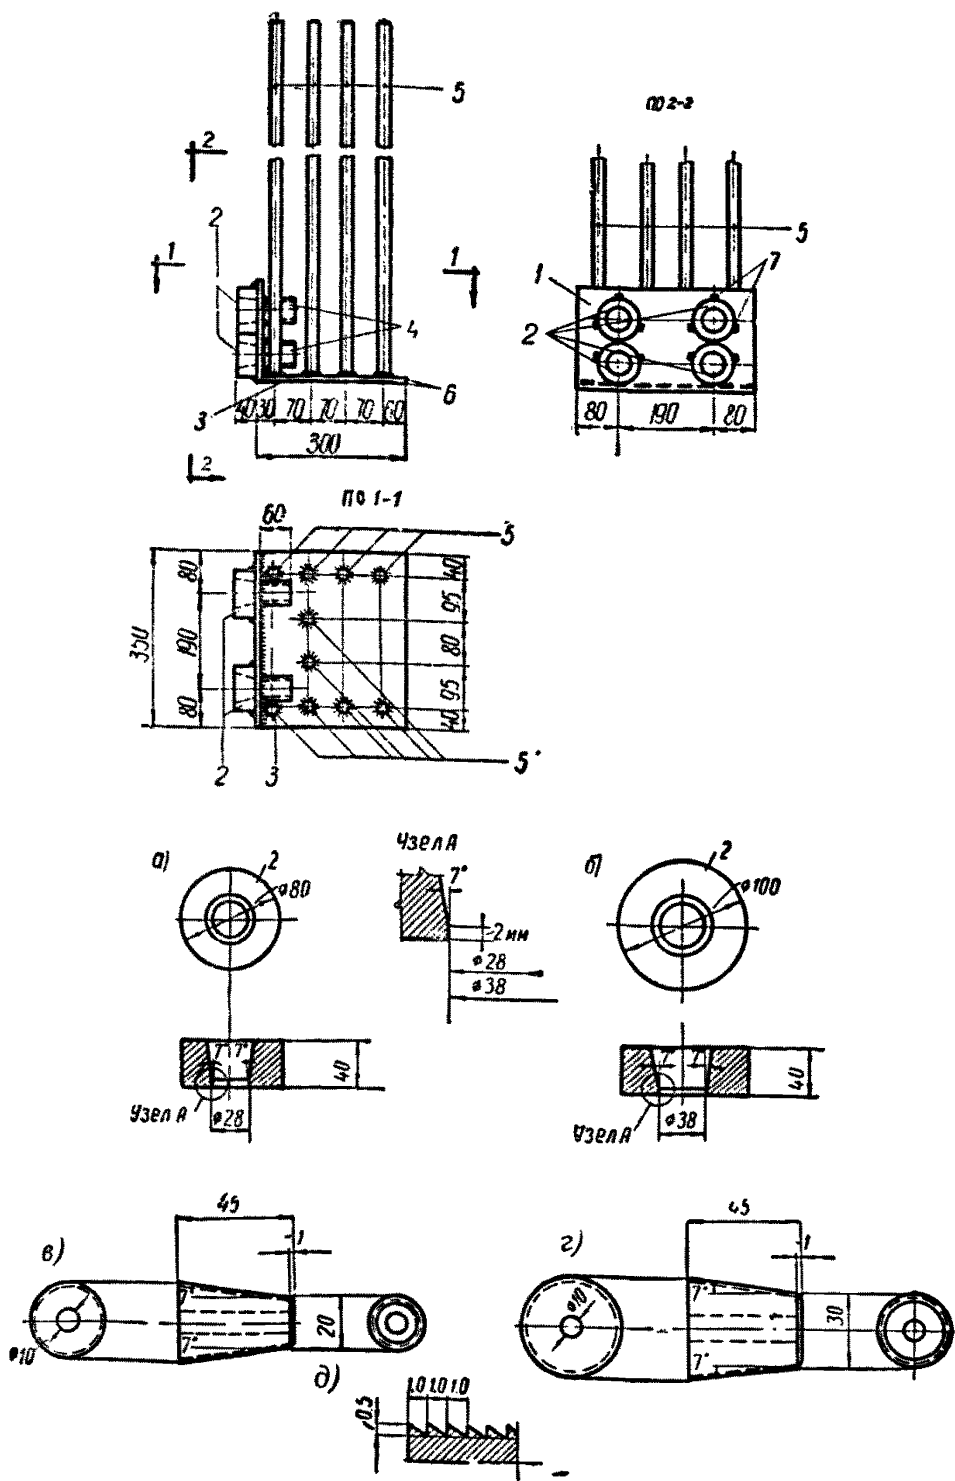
Стальные закладные детали для анкерки арматурных пучков на конце элемента
